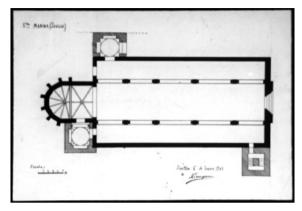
Planta de Sta. Marina por Vicente Lampérez (1903)
